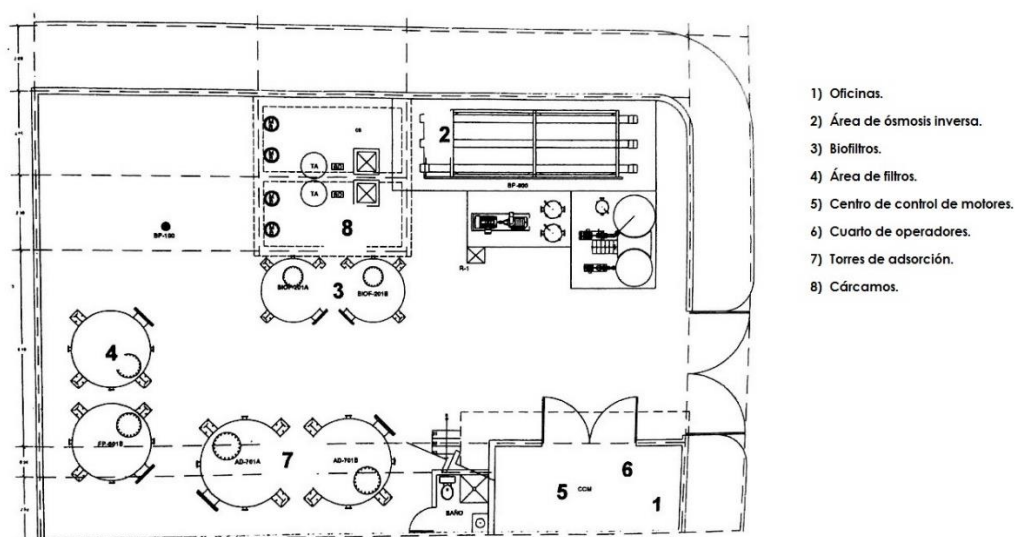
Vista en planta de la PP Santa Catarina 13
